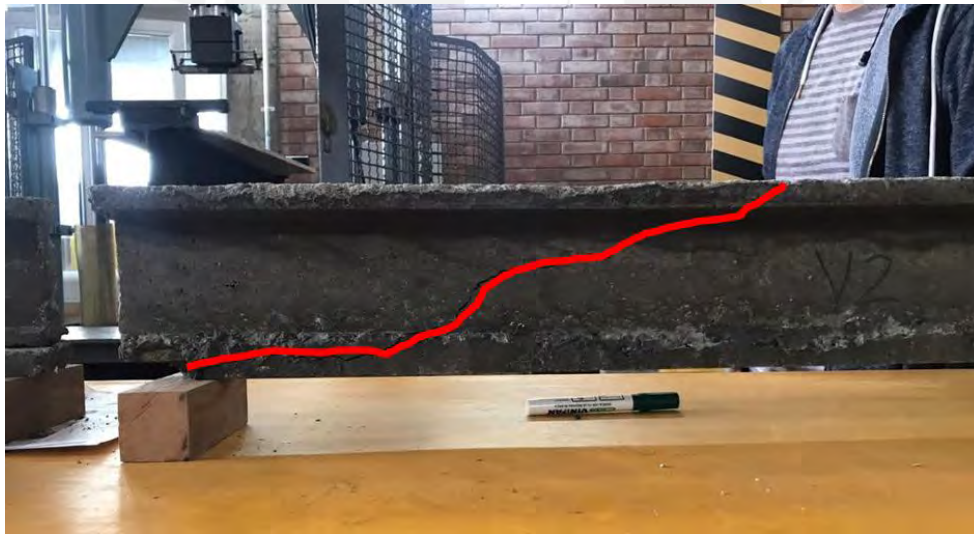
Grieta de falla de la viga V – 02
